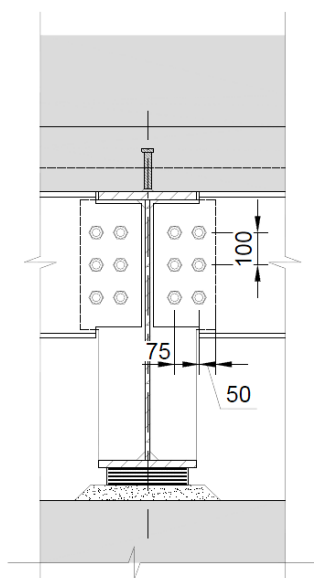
Uniones de vigas transversales- Puente entre unidades
